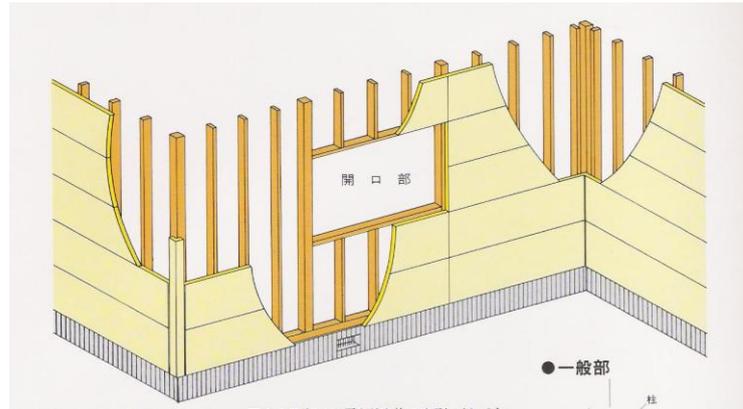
Wood Frame: Montantes e guias em madeira (YTONG, 2000, p . 06)
